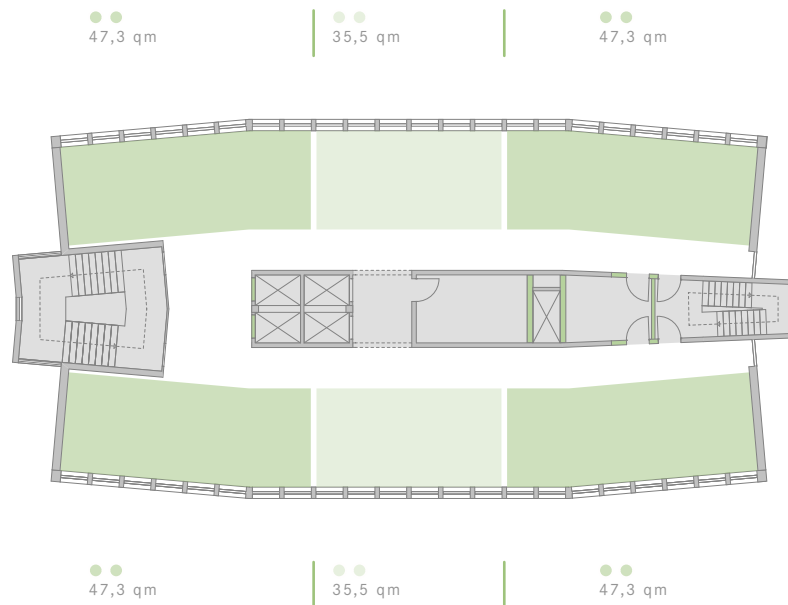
Grundriss Umbau - Wohnungsaufteilung
